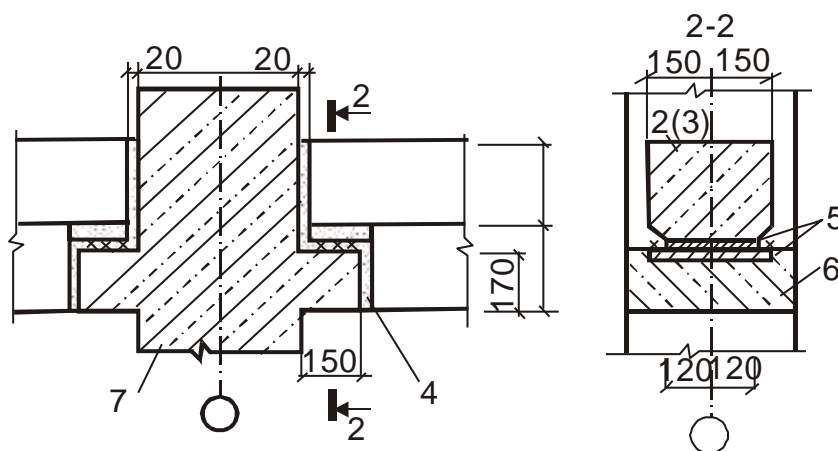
Детали сечений сопряжений несущих конструкций:
